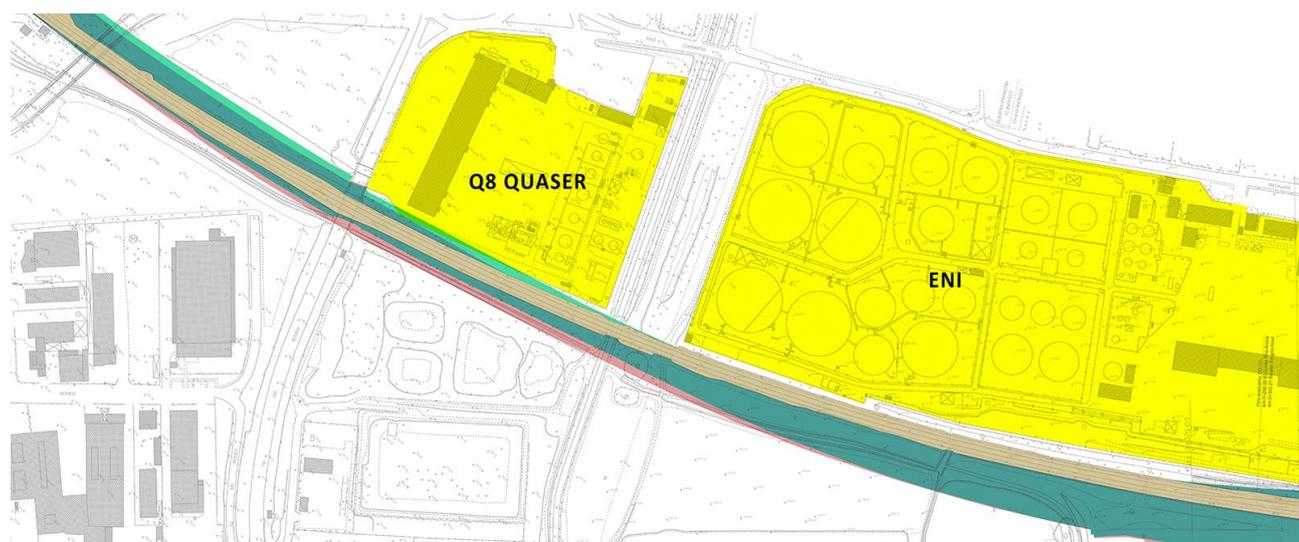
Il confronto tra le due soluzioni di tracciato dove si vede che rispetto al PD2013 la sede ferroviaria attuale, a parità di sezione si sposta leggermente a sud, allontanandosi della Stabilimento Q8.
